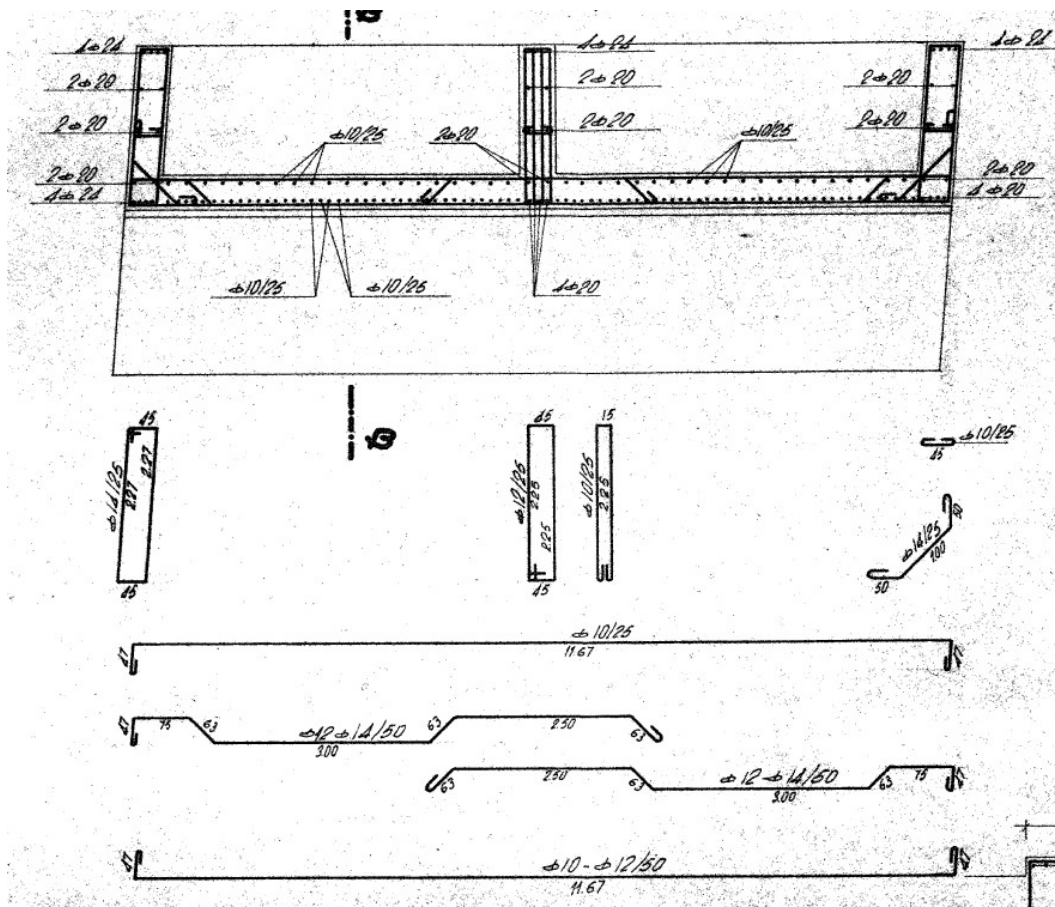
Documento as-built “Viadotto rampa interconnessione dell’autostrada A14 al km 14+346” – Sezione orizzontale con armature spalla.
